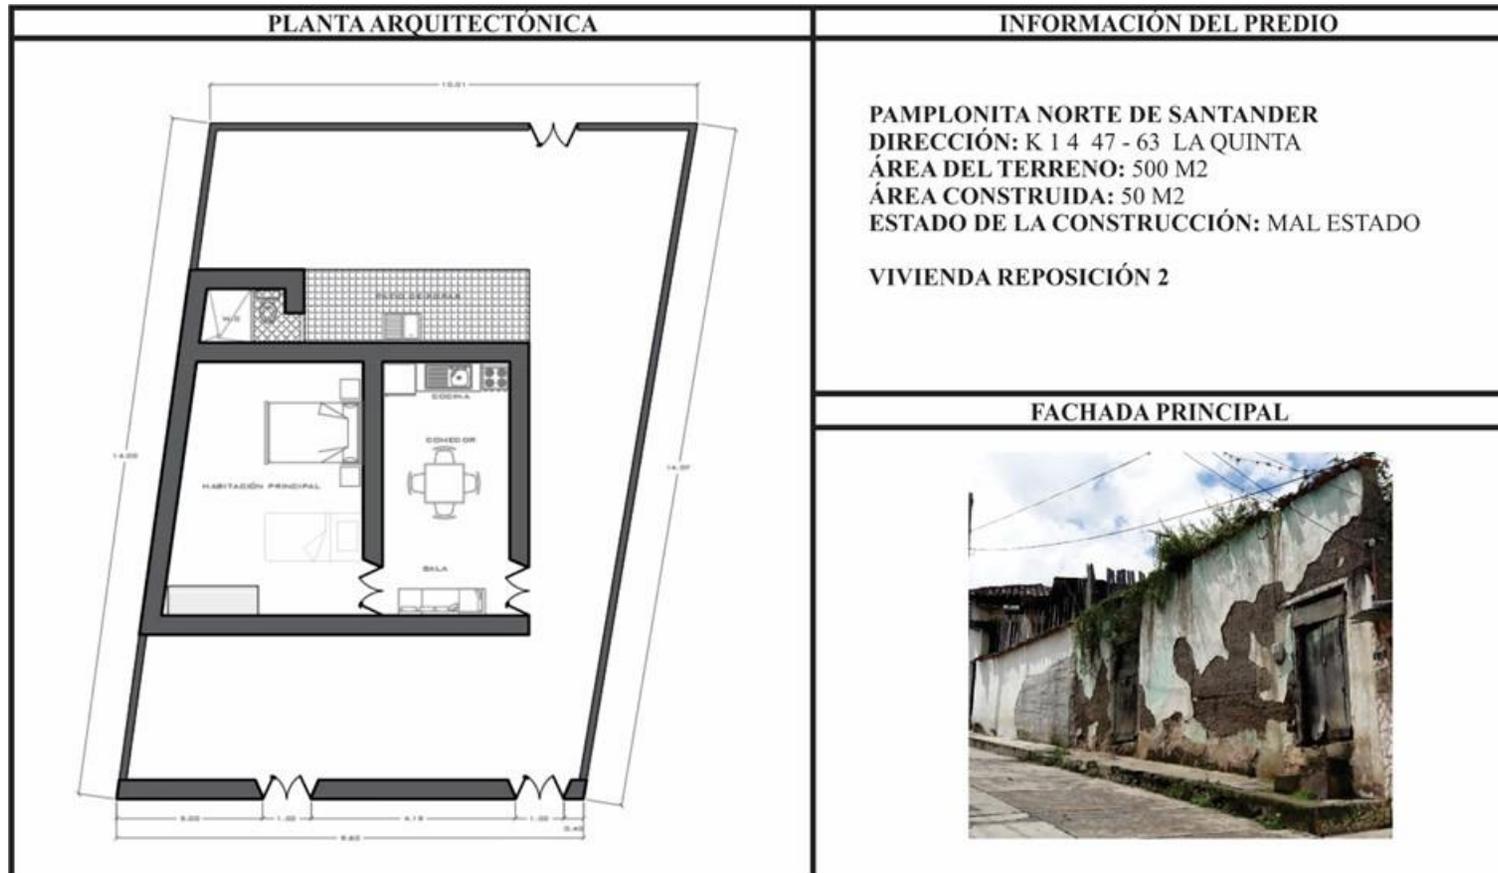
Vivienda Por Reposición 1 Planos 2
